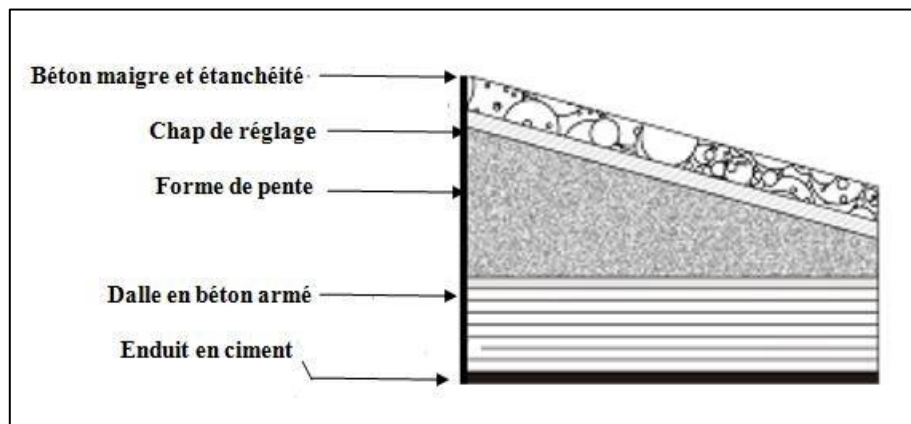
coupe transversale d'un plancher terrasse inaccessible.
